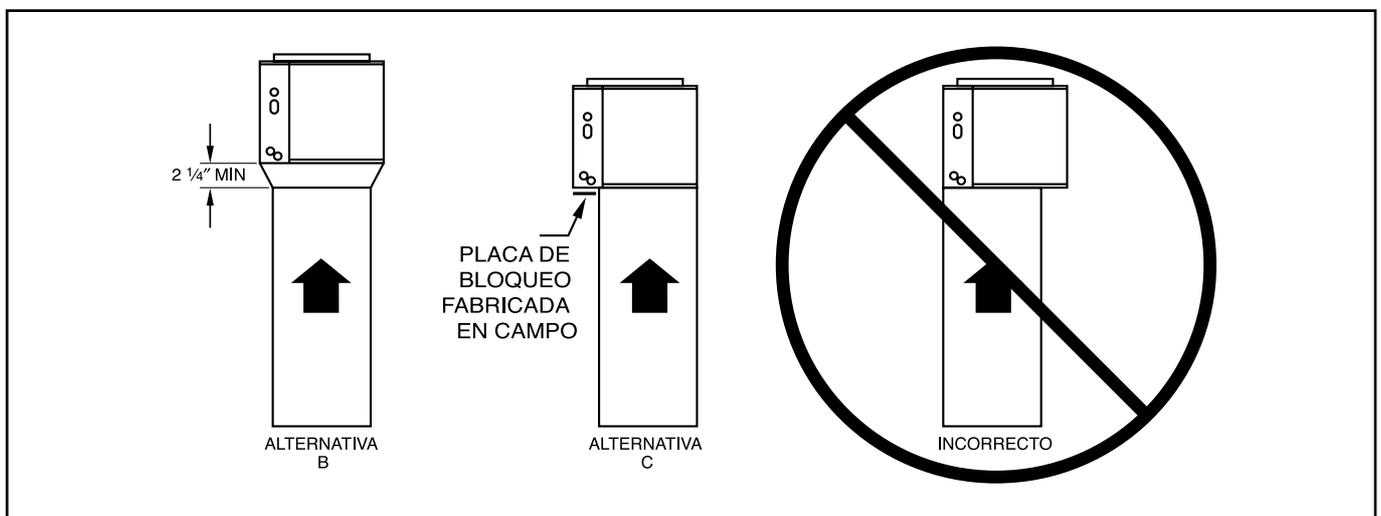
Posiciones Alternativas de Montaje de la Serpentina.
